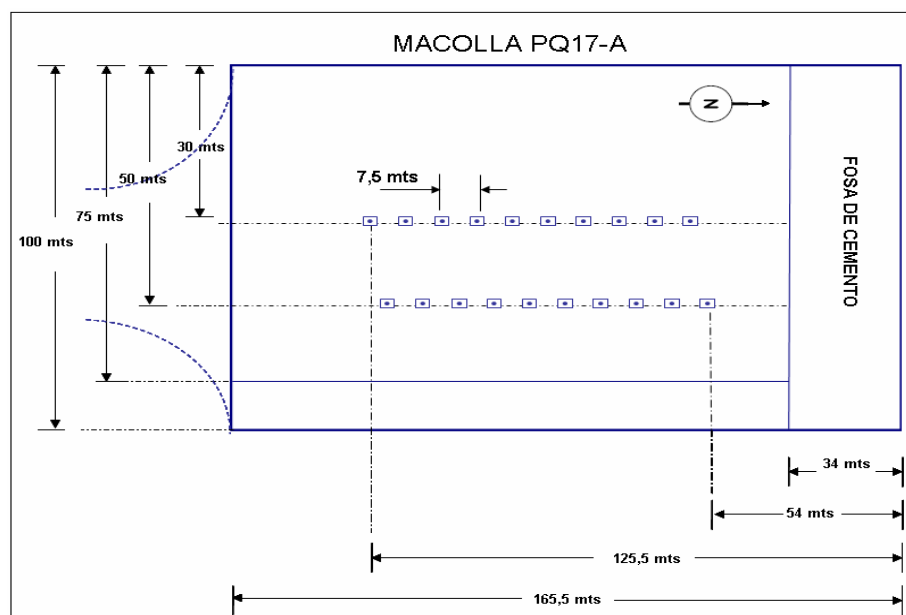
Vista en planta de la Macolla PQ17-A ubicada en el Distrito Cabrutica.
